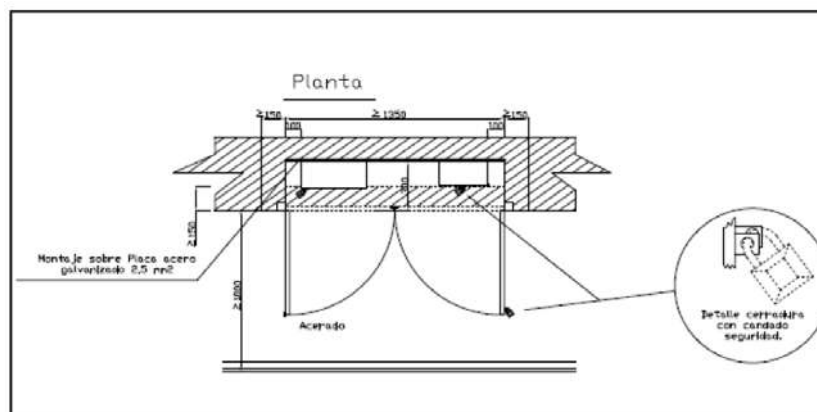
Instalación CGP y CS montaje horizontal. Planta.
